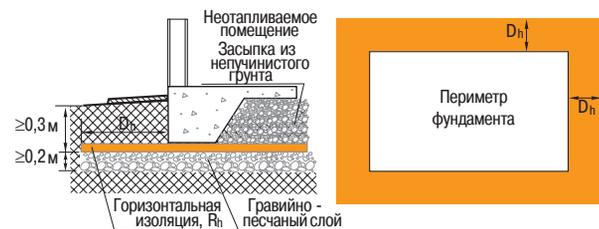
Схема поперечного разреза и план расположения изоляционных плит «Пеноплэкс®» для неотапливаемых помещений
